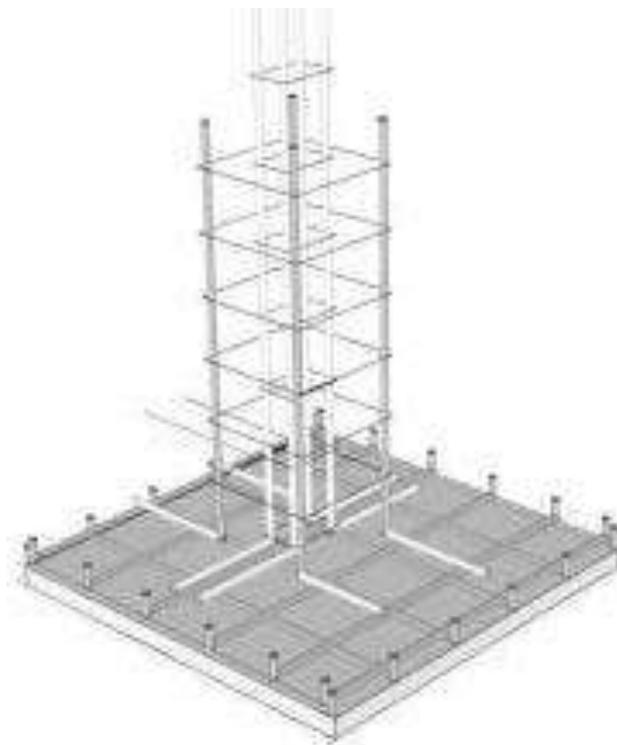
Ejemplo de zapata aislada, tomada de Bibliocad, https://www.bibliocad.com/es/biblioteca/zapata-aislada_104864/, febrero del 2019
